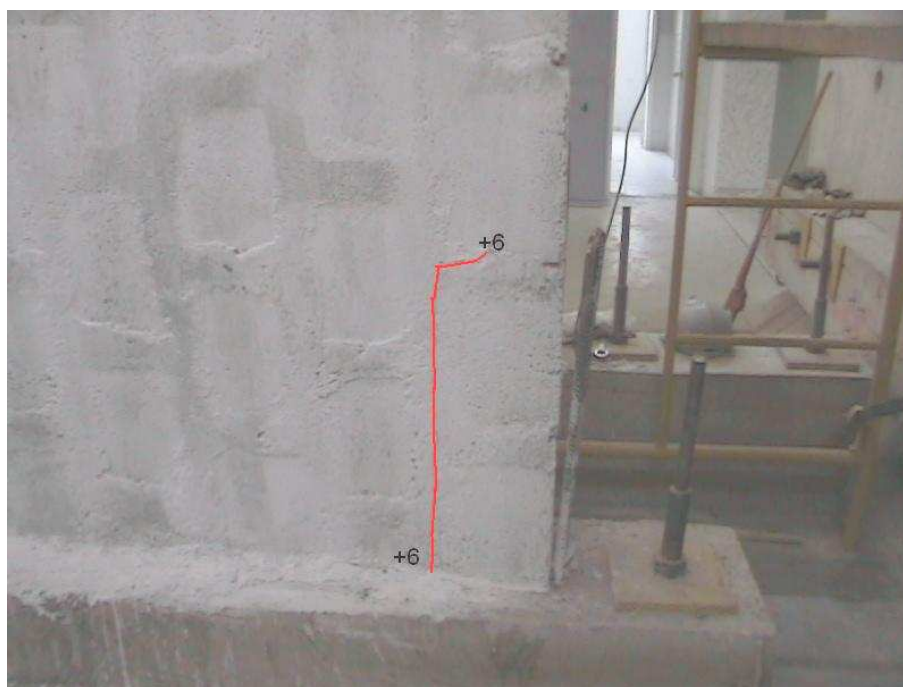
Primera fisura en pie de columneta derecha a 6 t de carga positiva
